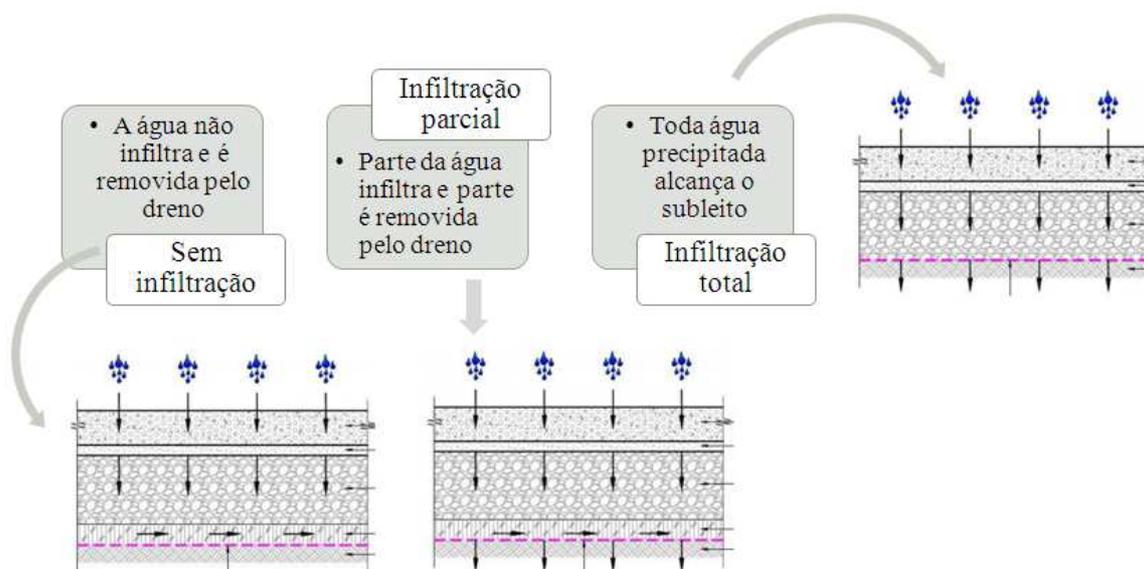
Sistemas de infiltração dos pavimentos permeáveis. Fonte: Adaptado de Ono, 2018
